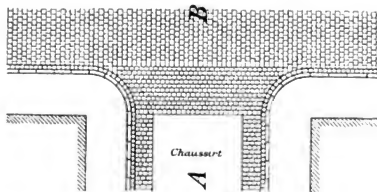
Straßenkreuzung mit Durchführung senkrechter Pflasterreihen. M. 1 : 400.
